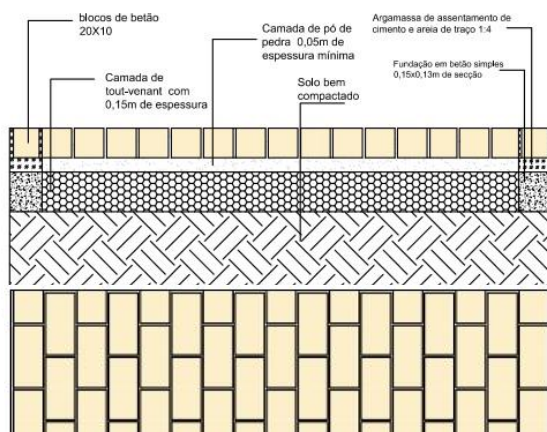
Proposta: Pormenores Construtivos, pavimento pedonal, pavê amarelo torrado. Fonte: Autor; Autocad pelo Autor, (Anexo 5)
